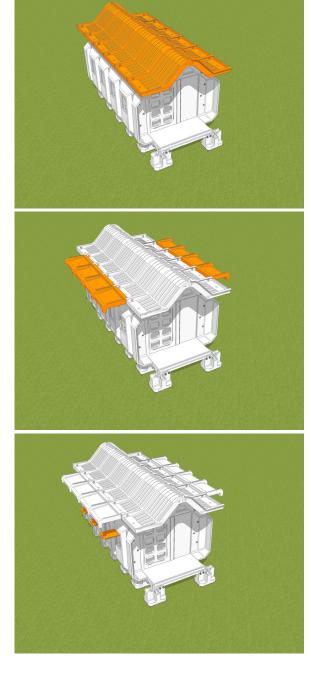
Proceso de ensamblaje de la UNIDAD (Pasos 8 al 10). Fuente: Elaboración propia (2018).
